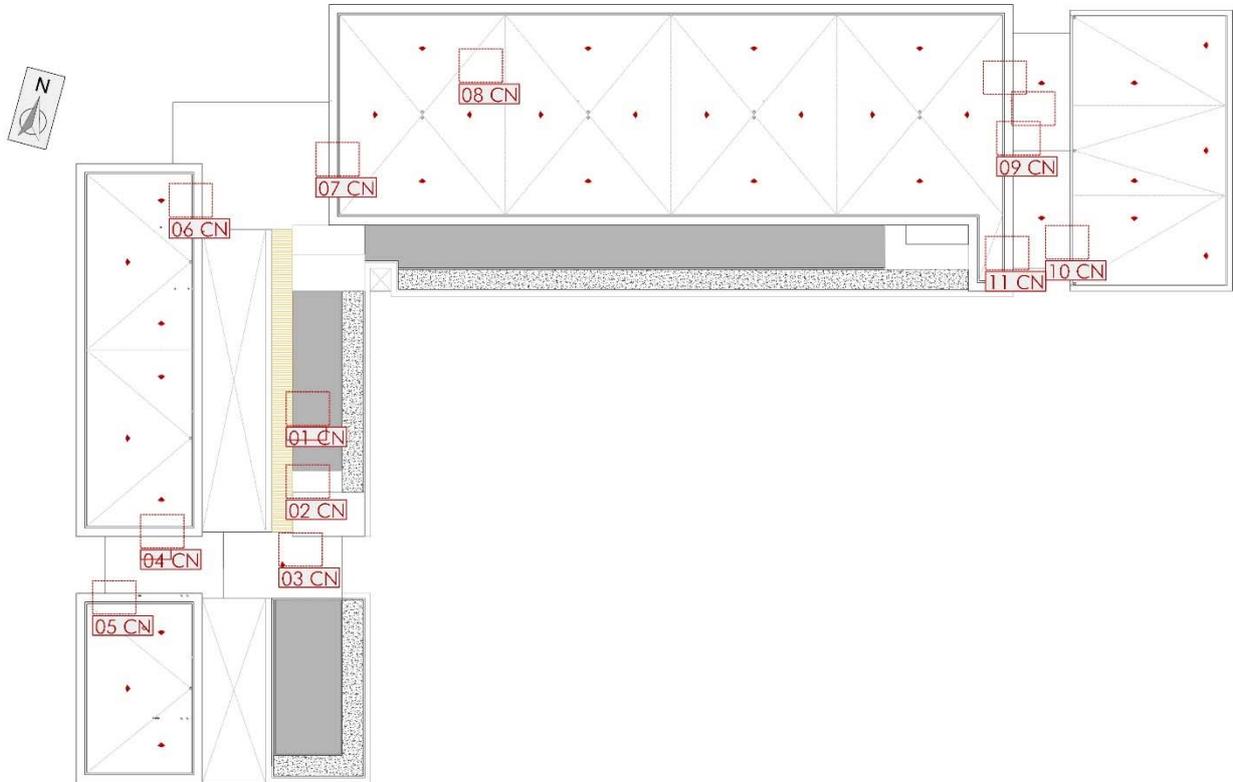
Imagen en la que se aprecian las zonas de obstáculo a la circulación detectados dentro de la cubierta
